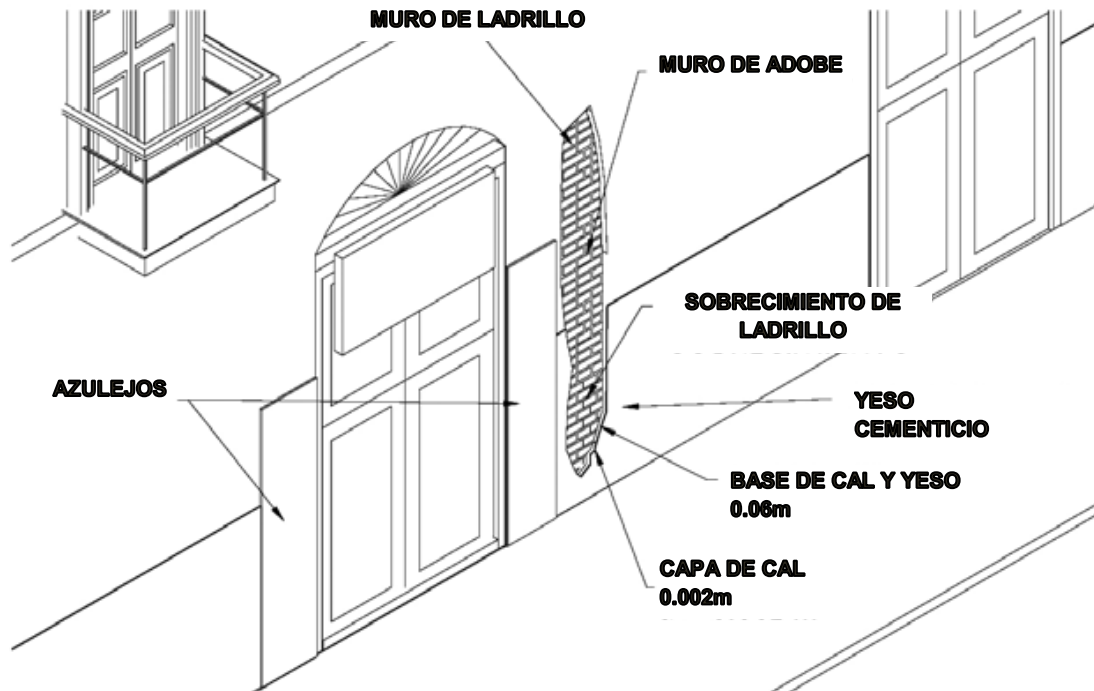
Esquema de la estructura de muros portantes exteriores [1]
